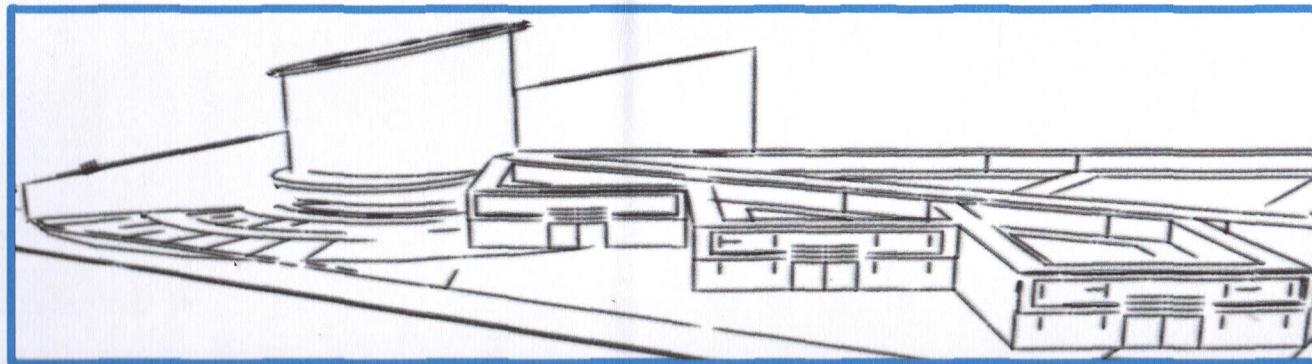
PLAN DE MASSE DE NOTRE PROJET
